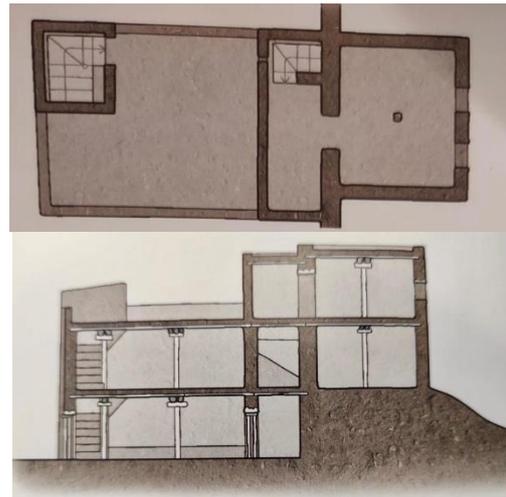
(2) _ Planta tipo y sección del dar 'Tatiouine'
